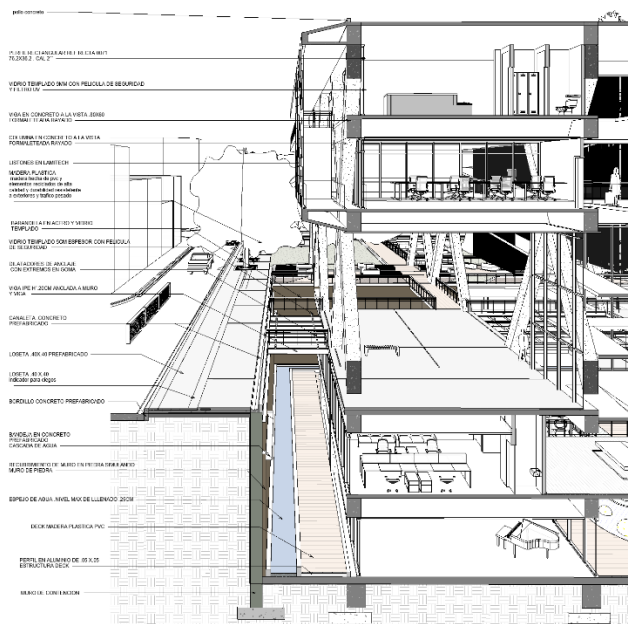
Corte fachada Proyecto Centro Amar Avanzar Marsella
